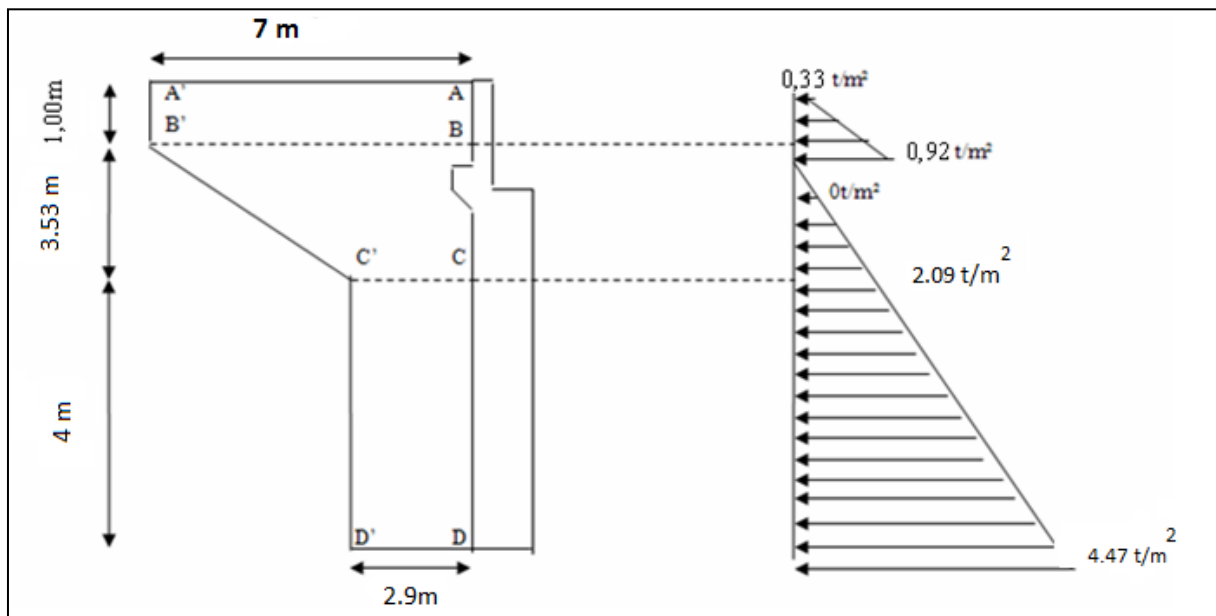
Efforts de poussées sur le mur en retour trouvée par la suite
